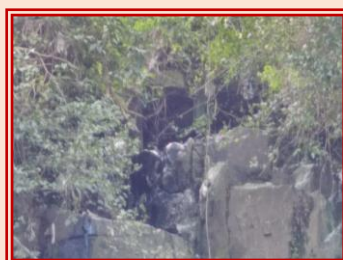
Arroio Pilão de pedras – nascente – construção do duto – fim da canalização.
